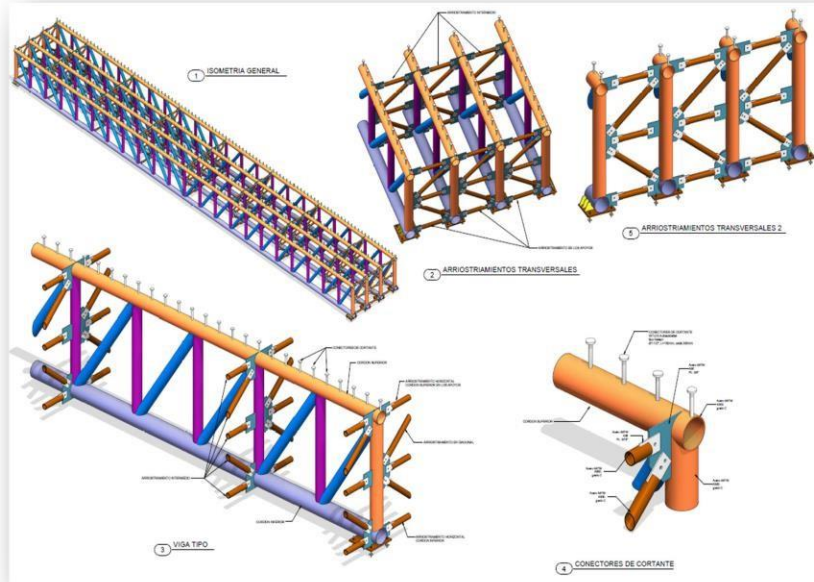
Isometría de la superestructura a construir con tubería metálica
